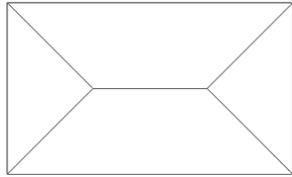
Abbildung IV. Isometrische Ansicht des einfachen Walmdaches.
